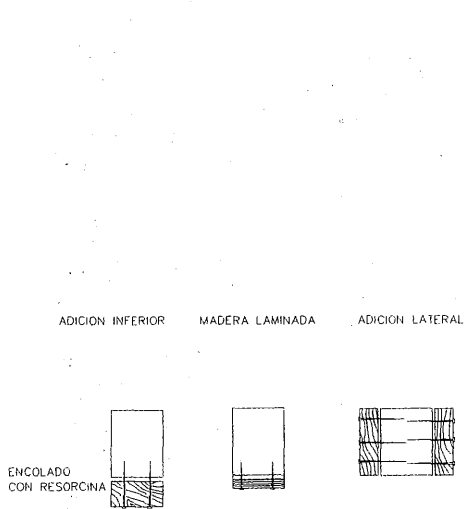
Refuerzos inferiores y laterales con elementos de madera.
